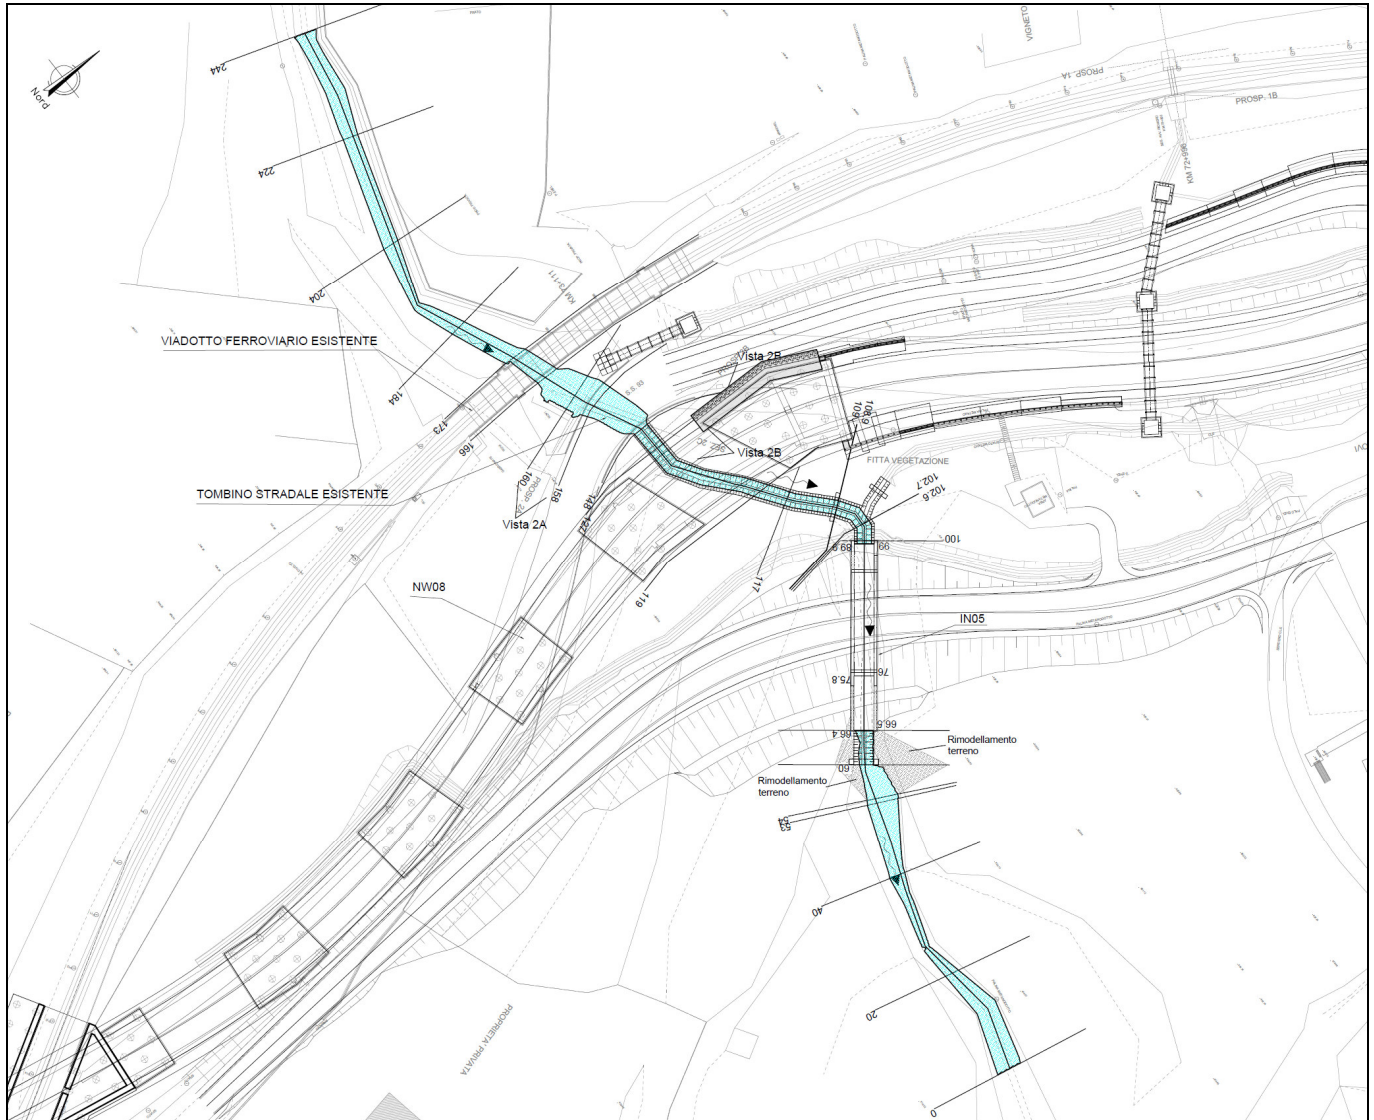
Asse Barile - Planimetria con sezioni di studio post operam
